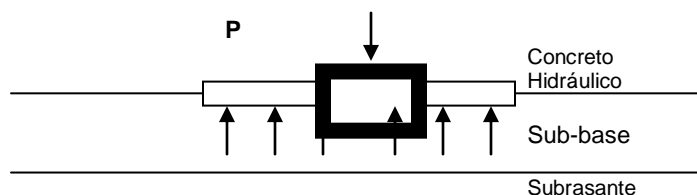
Concreto Hidráulico. Fuente apuntes de Construcción FI.
